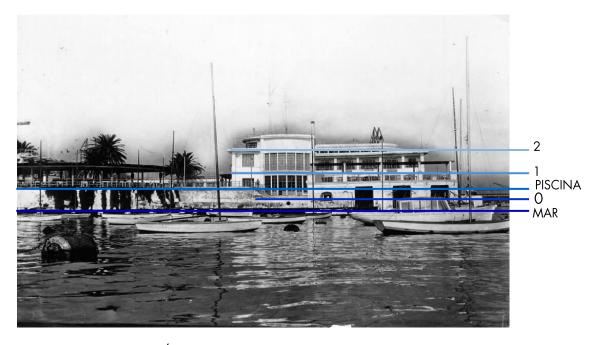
FUNDACIÓN GOERLICH. (1933). Vista desde el mar al acceso al garaje varadero.
